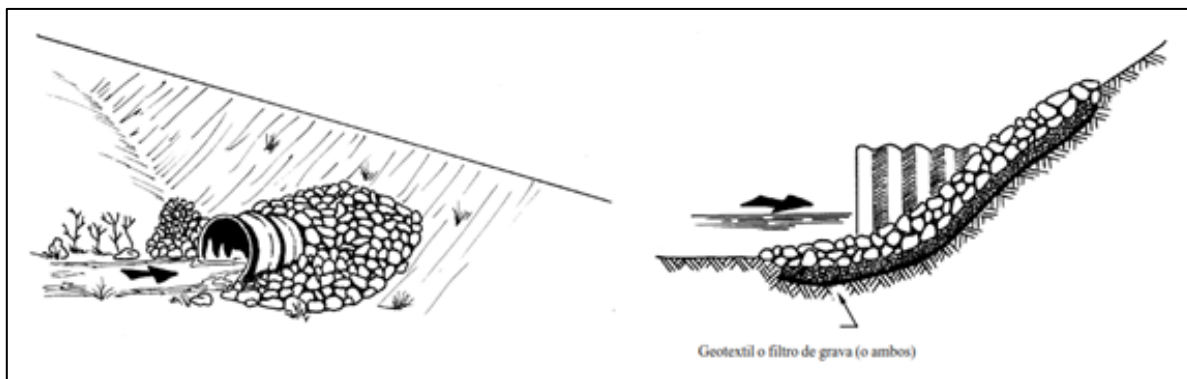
Protección contra la socavación en una alcantarilla circular.
